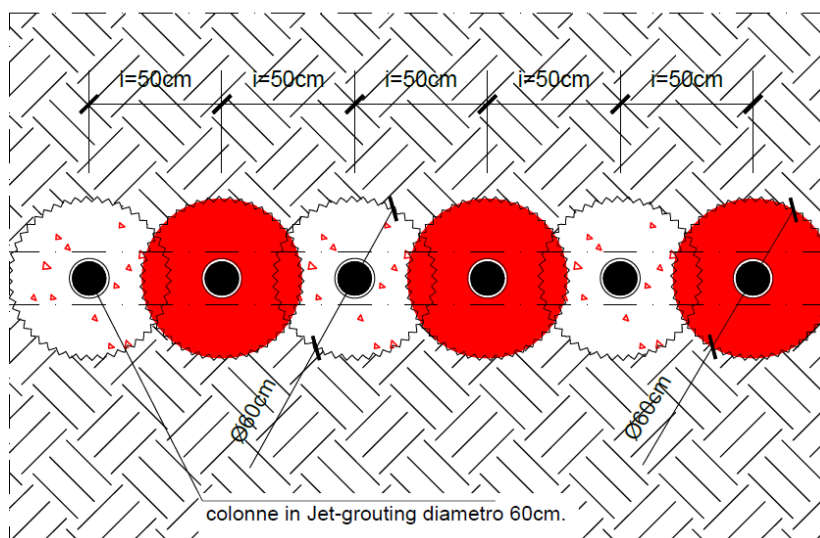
Disposizione planimetrica delle colonne in jet grouting a formare lo schermo di impermeabilizzazione
